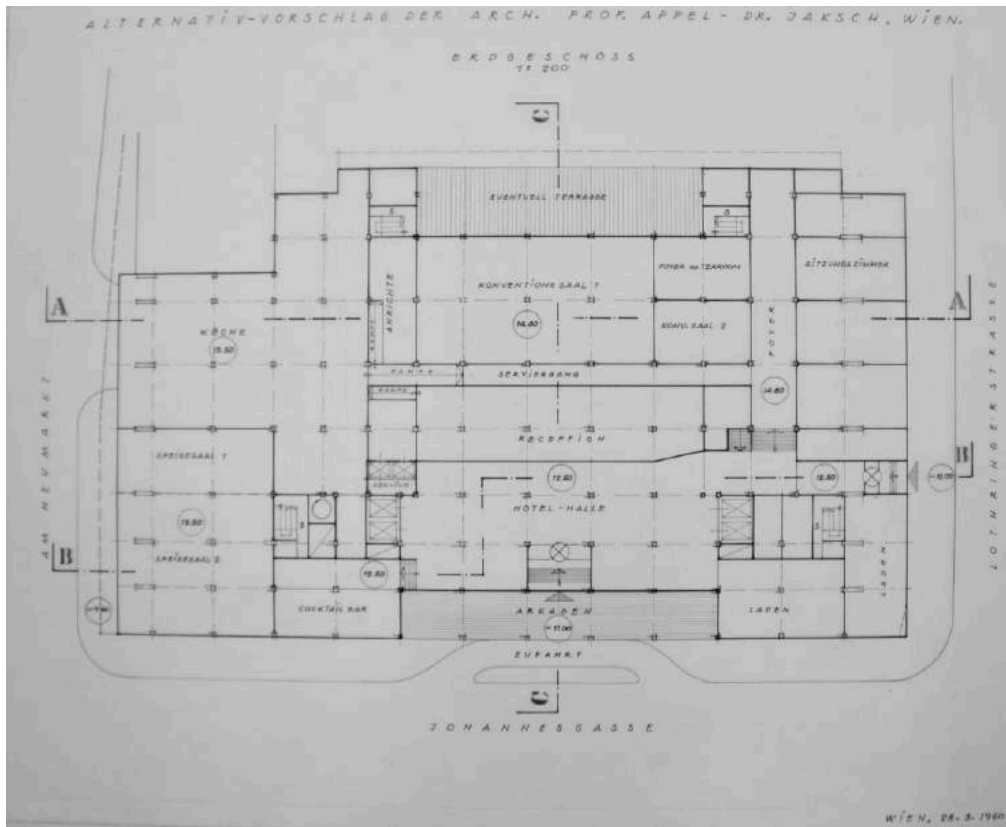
Wien, Alternativvorschlag Erdgeschoss, Carl Appel und Walter Jaksch, 1960
